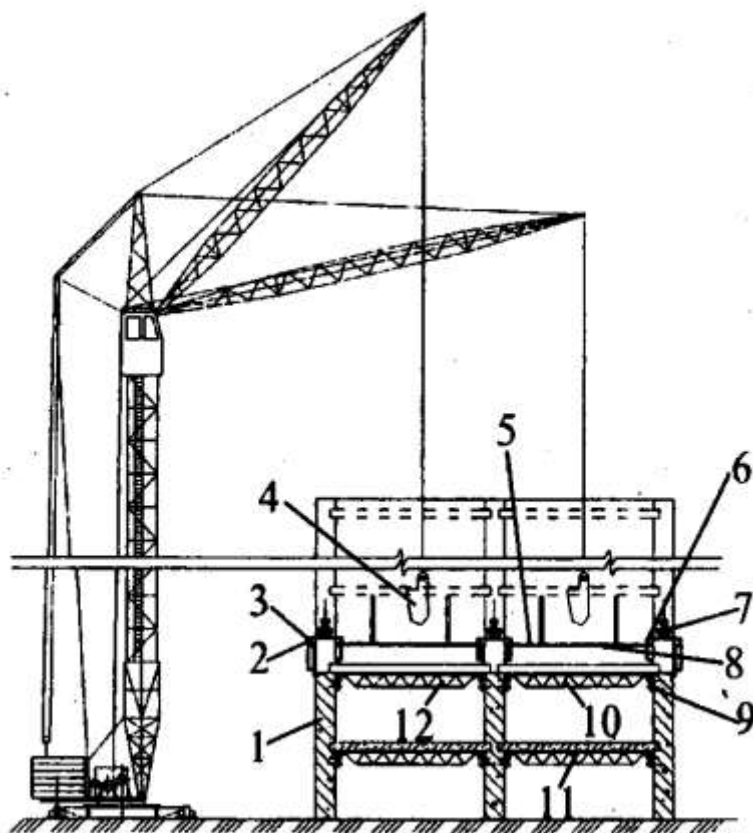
Бетонування міжповерхового перекриття циклічним методом:
